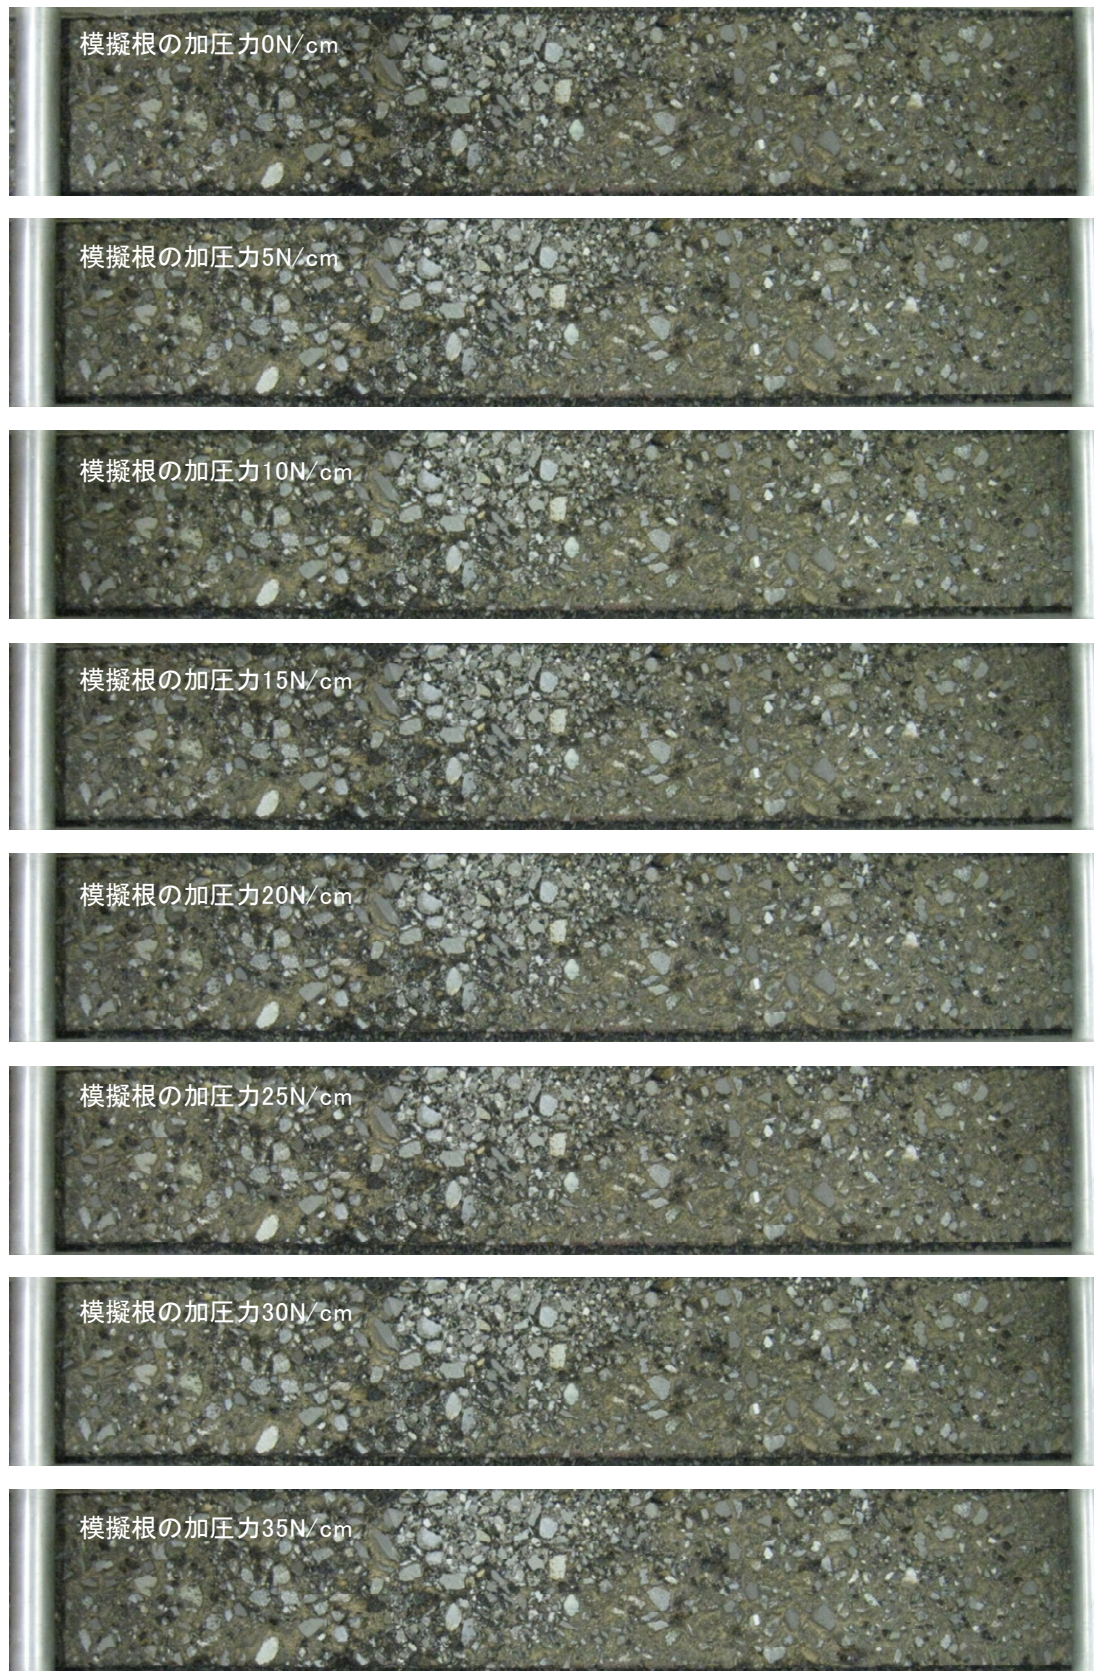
アスファルト舗装表面のひび割れ状態の一例(模擬根直上の砂層の厚さ20mm) 1/3
